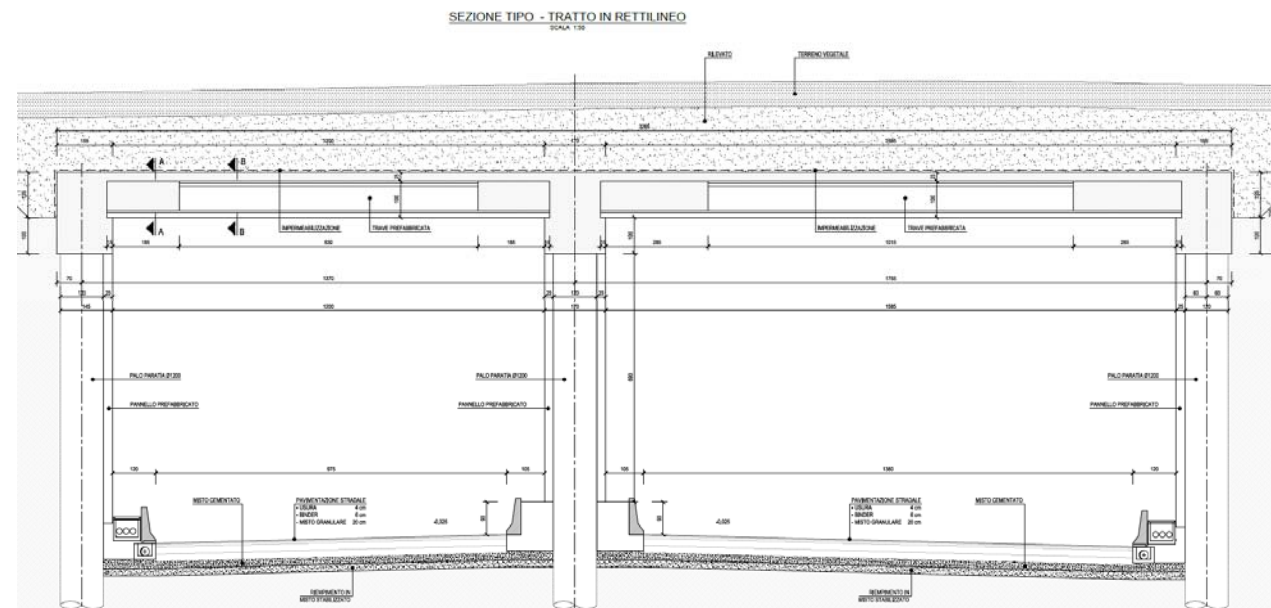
Galleria Chiatamura: Sezione Trasversale
